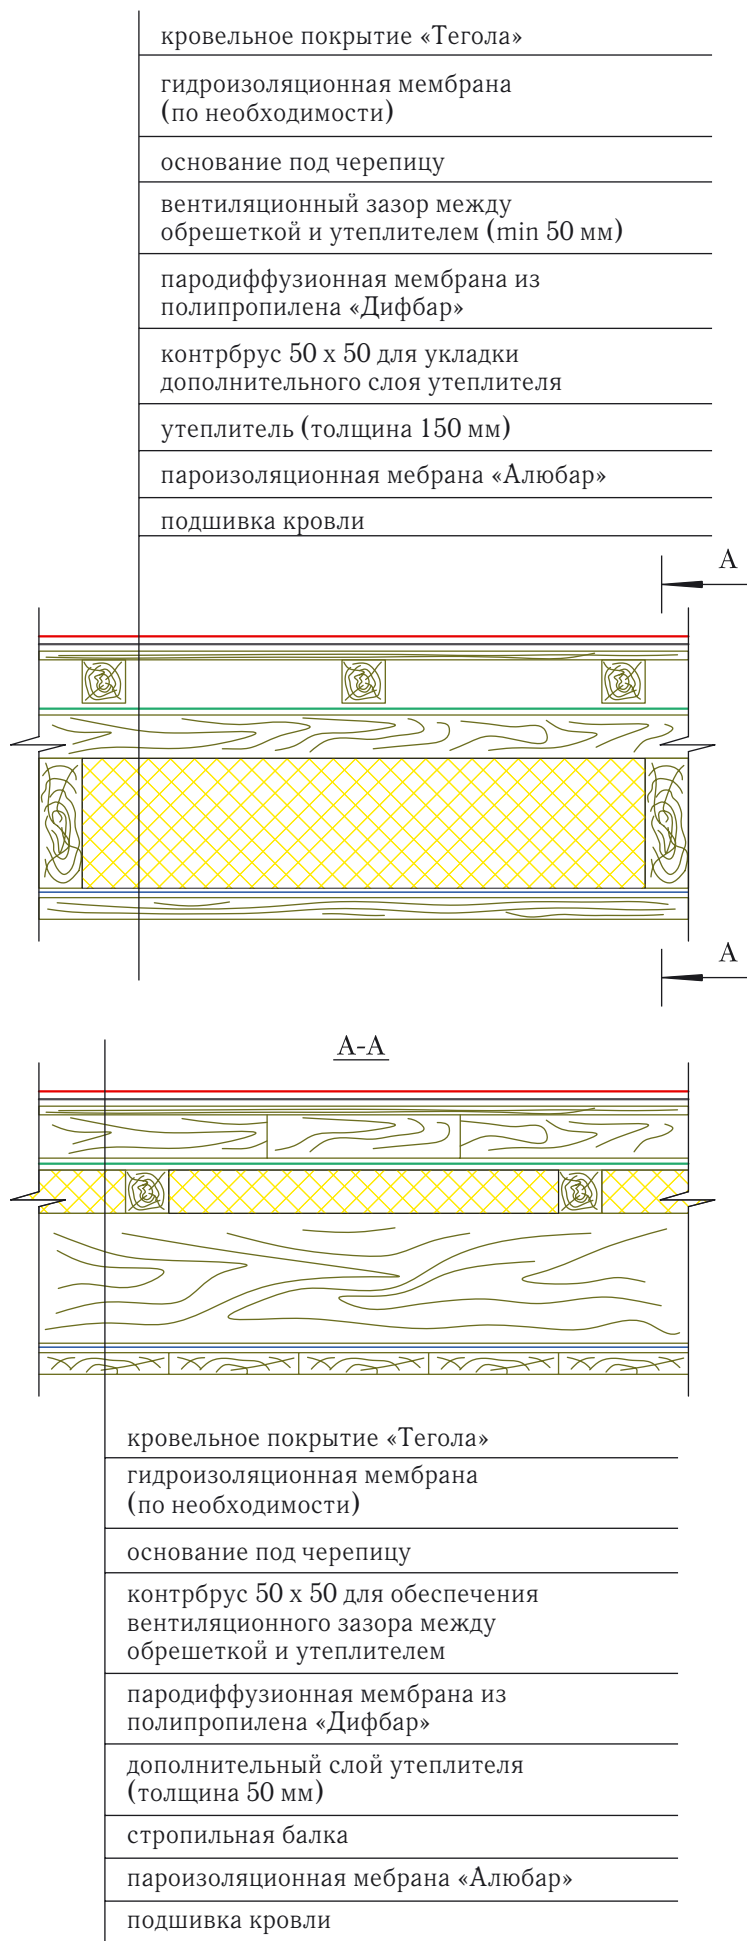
Разрез кровельного пирога «жилой мансарды»
